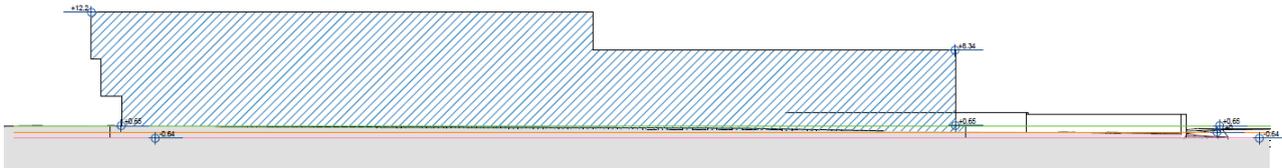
Sezione A-A [da Rilievo planimetrico e posizionamento dell'edificio nell'area]
